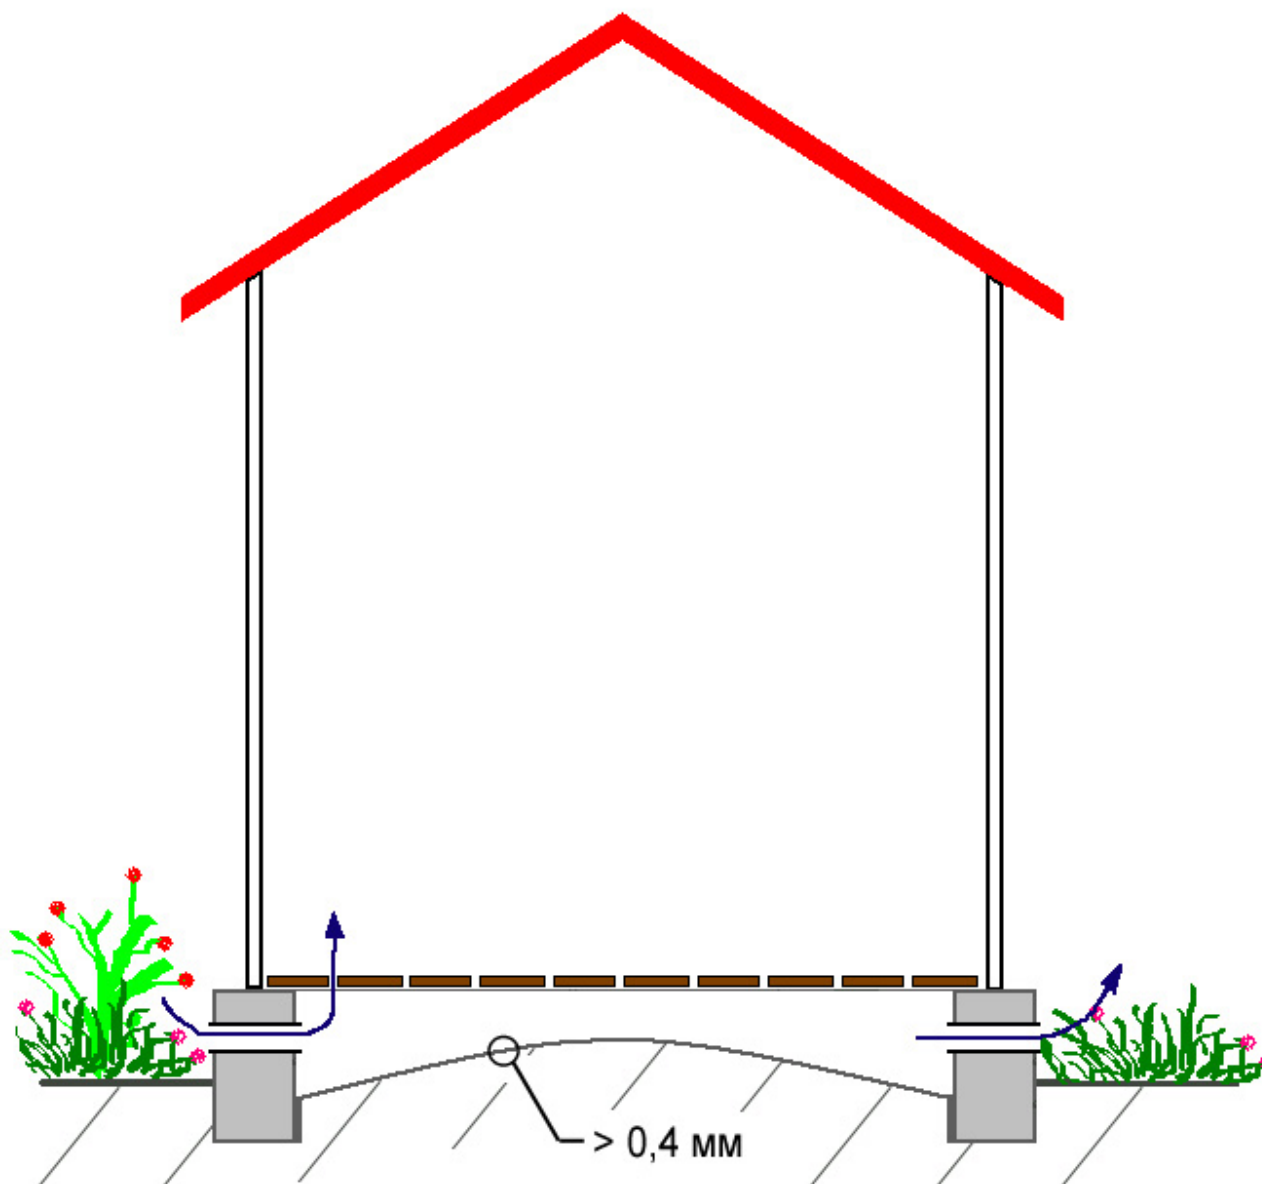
Здание, в подвале/подполе которого поверх грунта уложена пластиковая пленка, препятствующая поступлению в подпольное пространство насыщенного радоном грунтового воздуха и влаги. Грунт должен быть профилирован таким образом, чтобы наивысшая точка располагалась посередине подвала или подпола. Края пленки должны быть герметично соединены с фундаментными стенами. Отверстия в фундаментных стенах должны обеспечивать хорошую вентиляцию подпольного пространства
